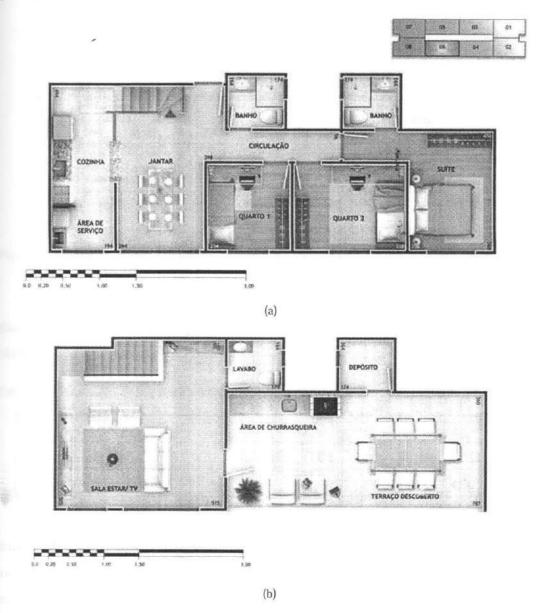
Planta dos pavimentos inferior (a) e superior (b) da UH de cobertura de um dos empreendimentos analisados. (Fonte: folder de propaganda da construtora)
